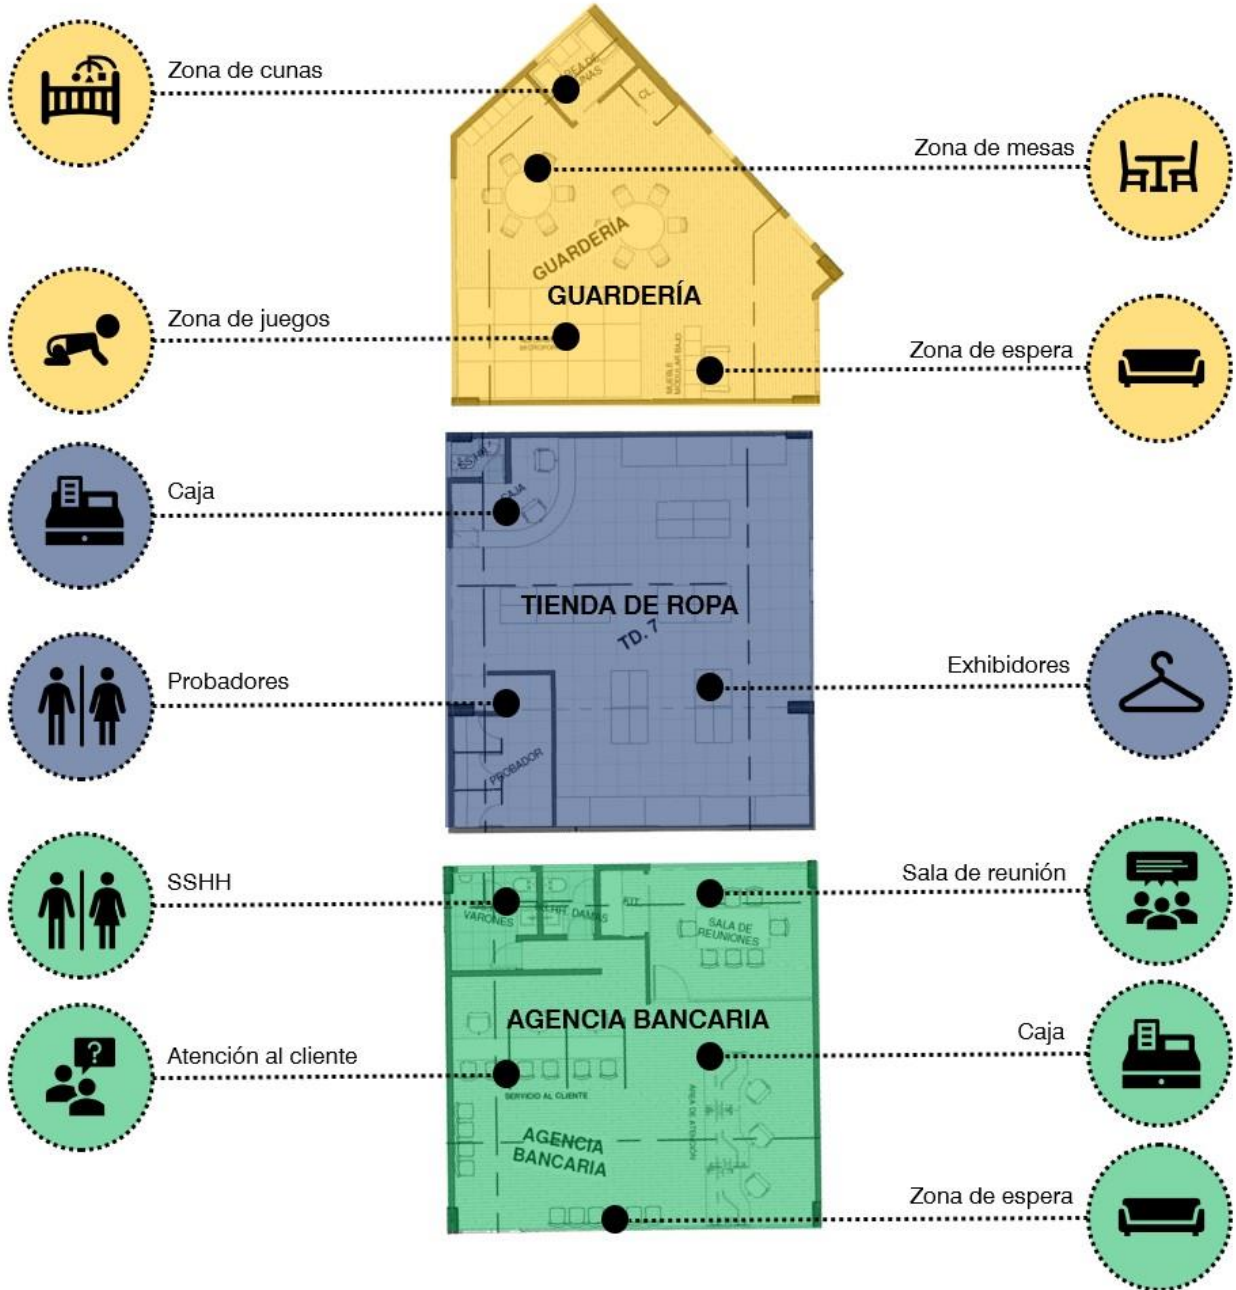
Tipología de tiendas del proyecto. Elaboración propia
